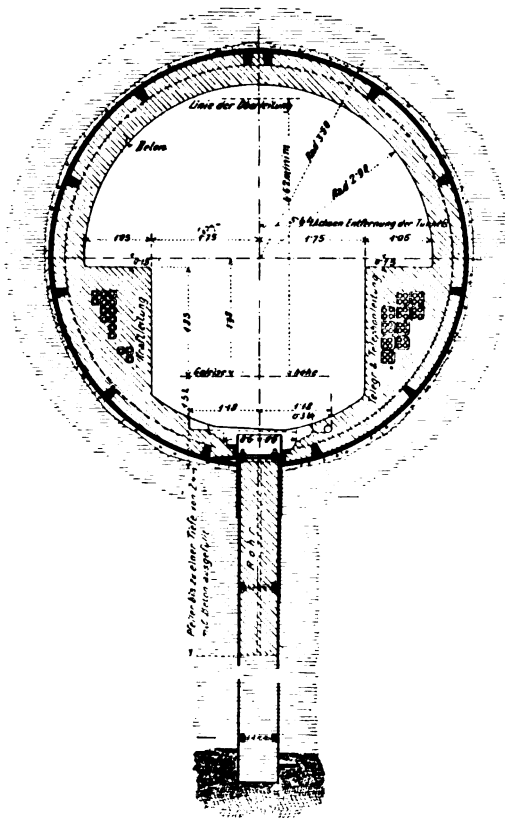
Querschnitt des North River-Tunnels mit eisernen Schraubpfählen.
